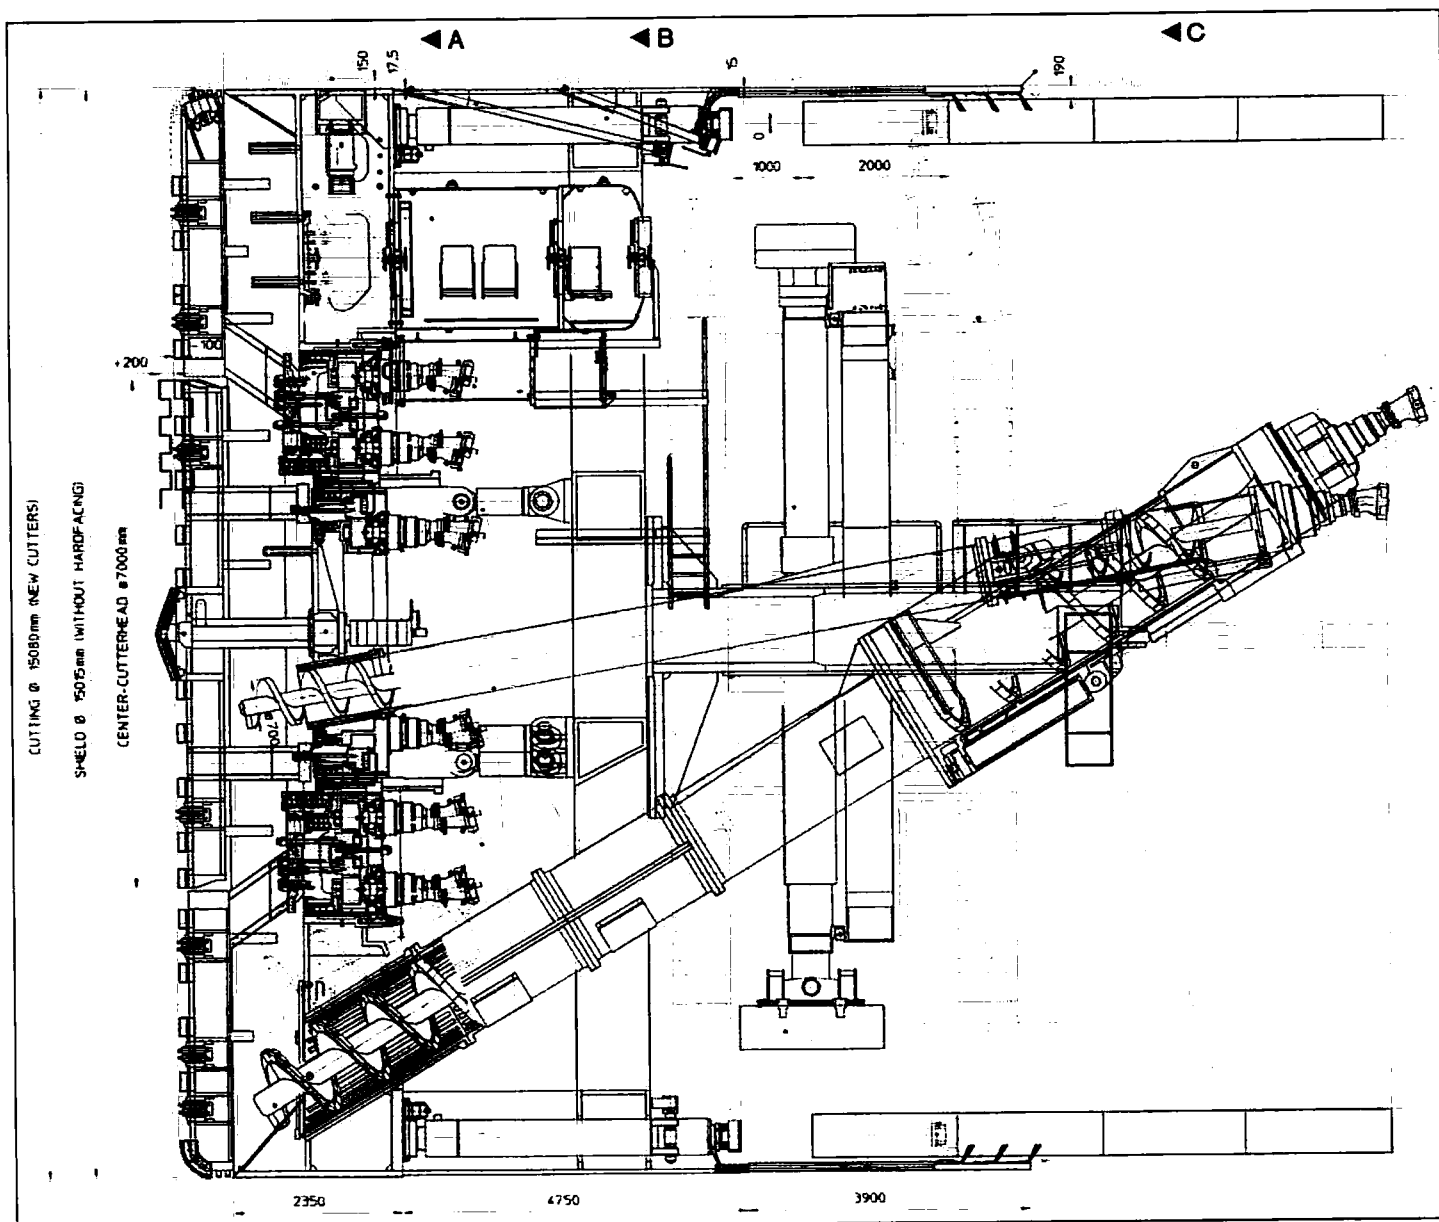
Máquina Herrenknecht. Sección de cabeza y escudo.
